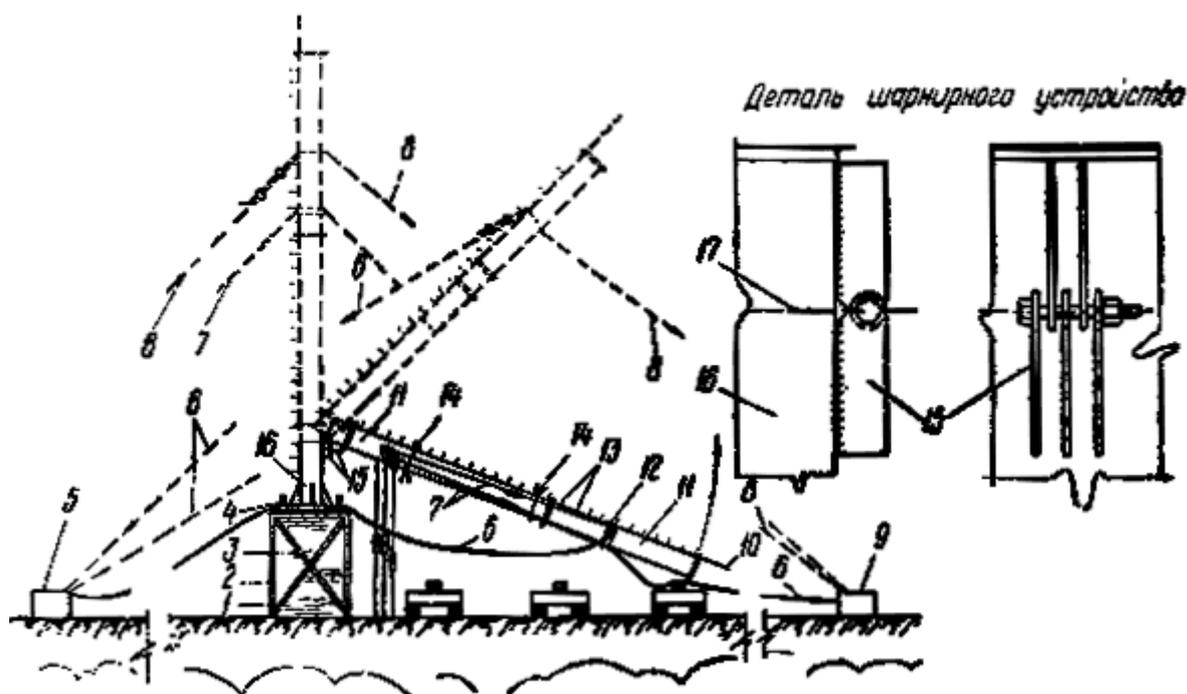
Схема подъема дымовой трубы с помощью шарнирного устройства:
